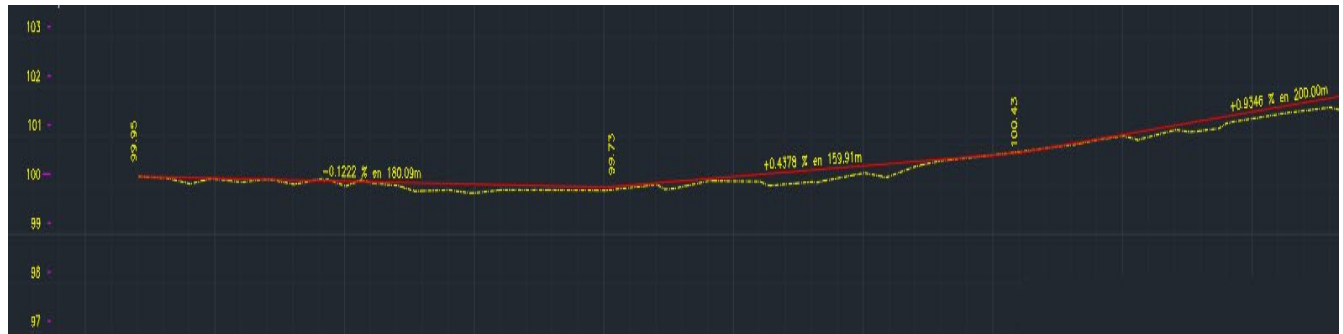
Nuevo Perfil de Proyecto Av. Heriberto Enríquez, comparado con TN seccionado con la nueva ubicación del eje de trazo. Fuente propia.
